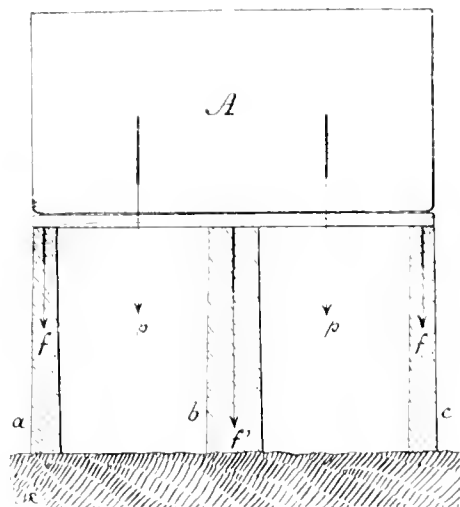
Elevation d'un réservoir reposant sur trois murs.
